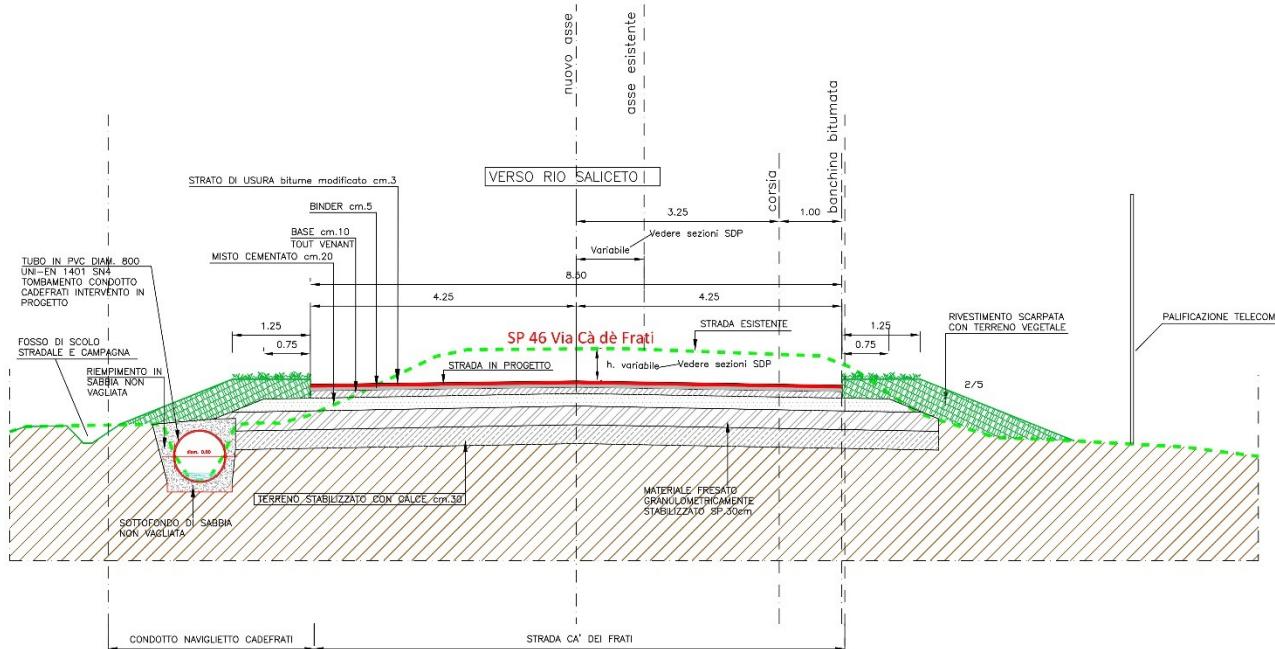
Sezione tipologica di progetto (lato Rolo)
